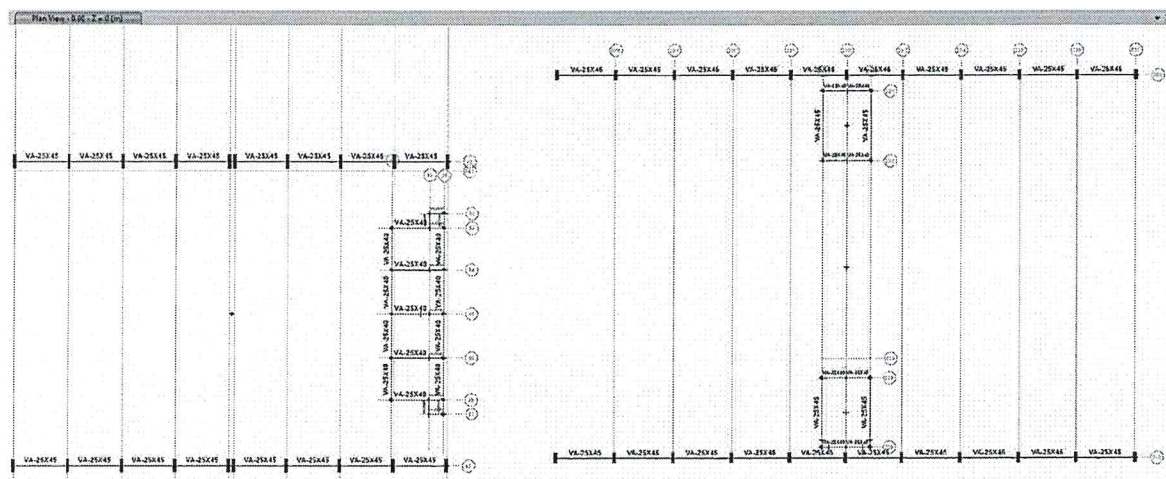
Vista en Planta del modelo estructural de la Edificación 19-20 sistémico analizado. Los elementos no estructurales fueron ingresados como cargas permanentes
